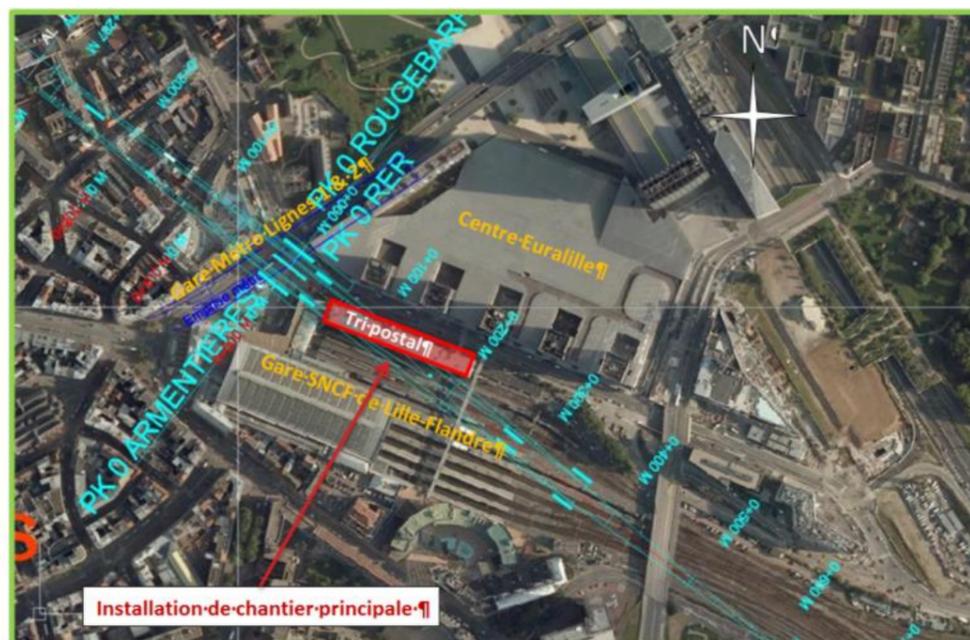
Ouvrages LRF du secteurs de la future gare souterraine de Lille Flandres
